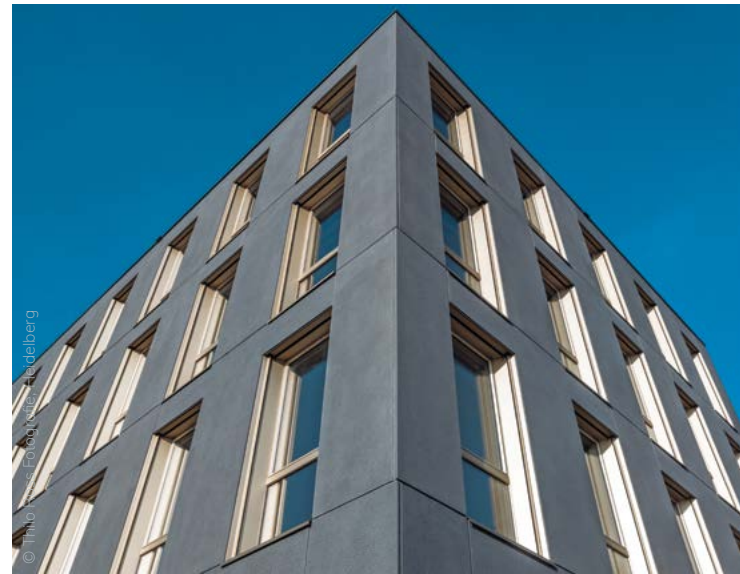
Sandwichfassade mit 3 cm dünner Vorsatzschale und textiler Bewehrung, Dreßler Bau.
